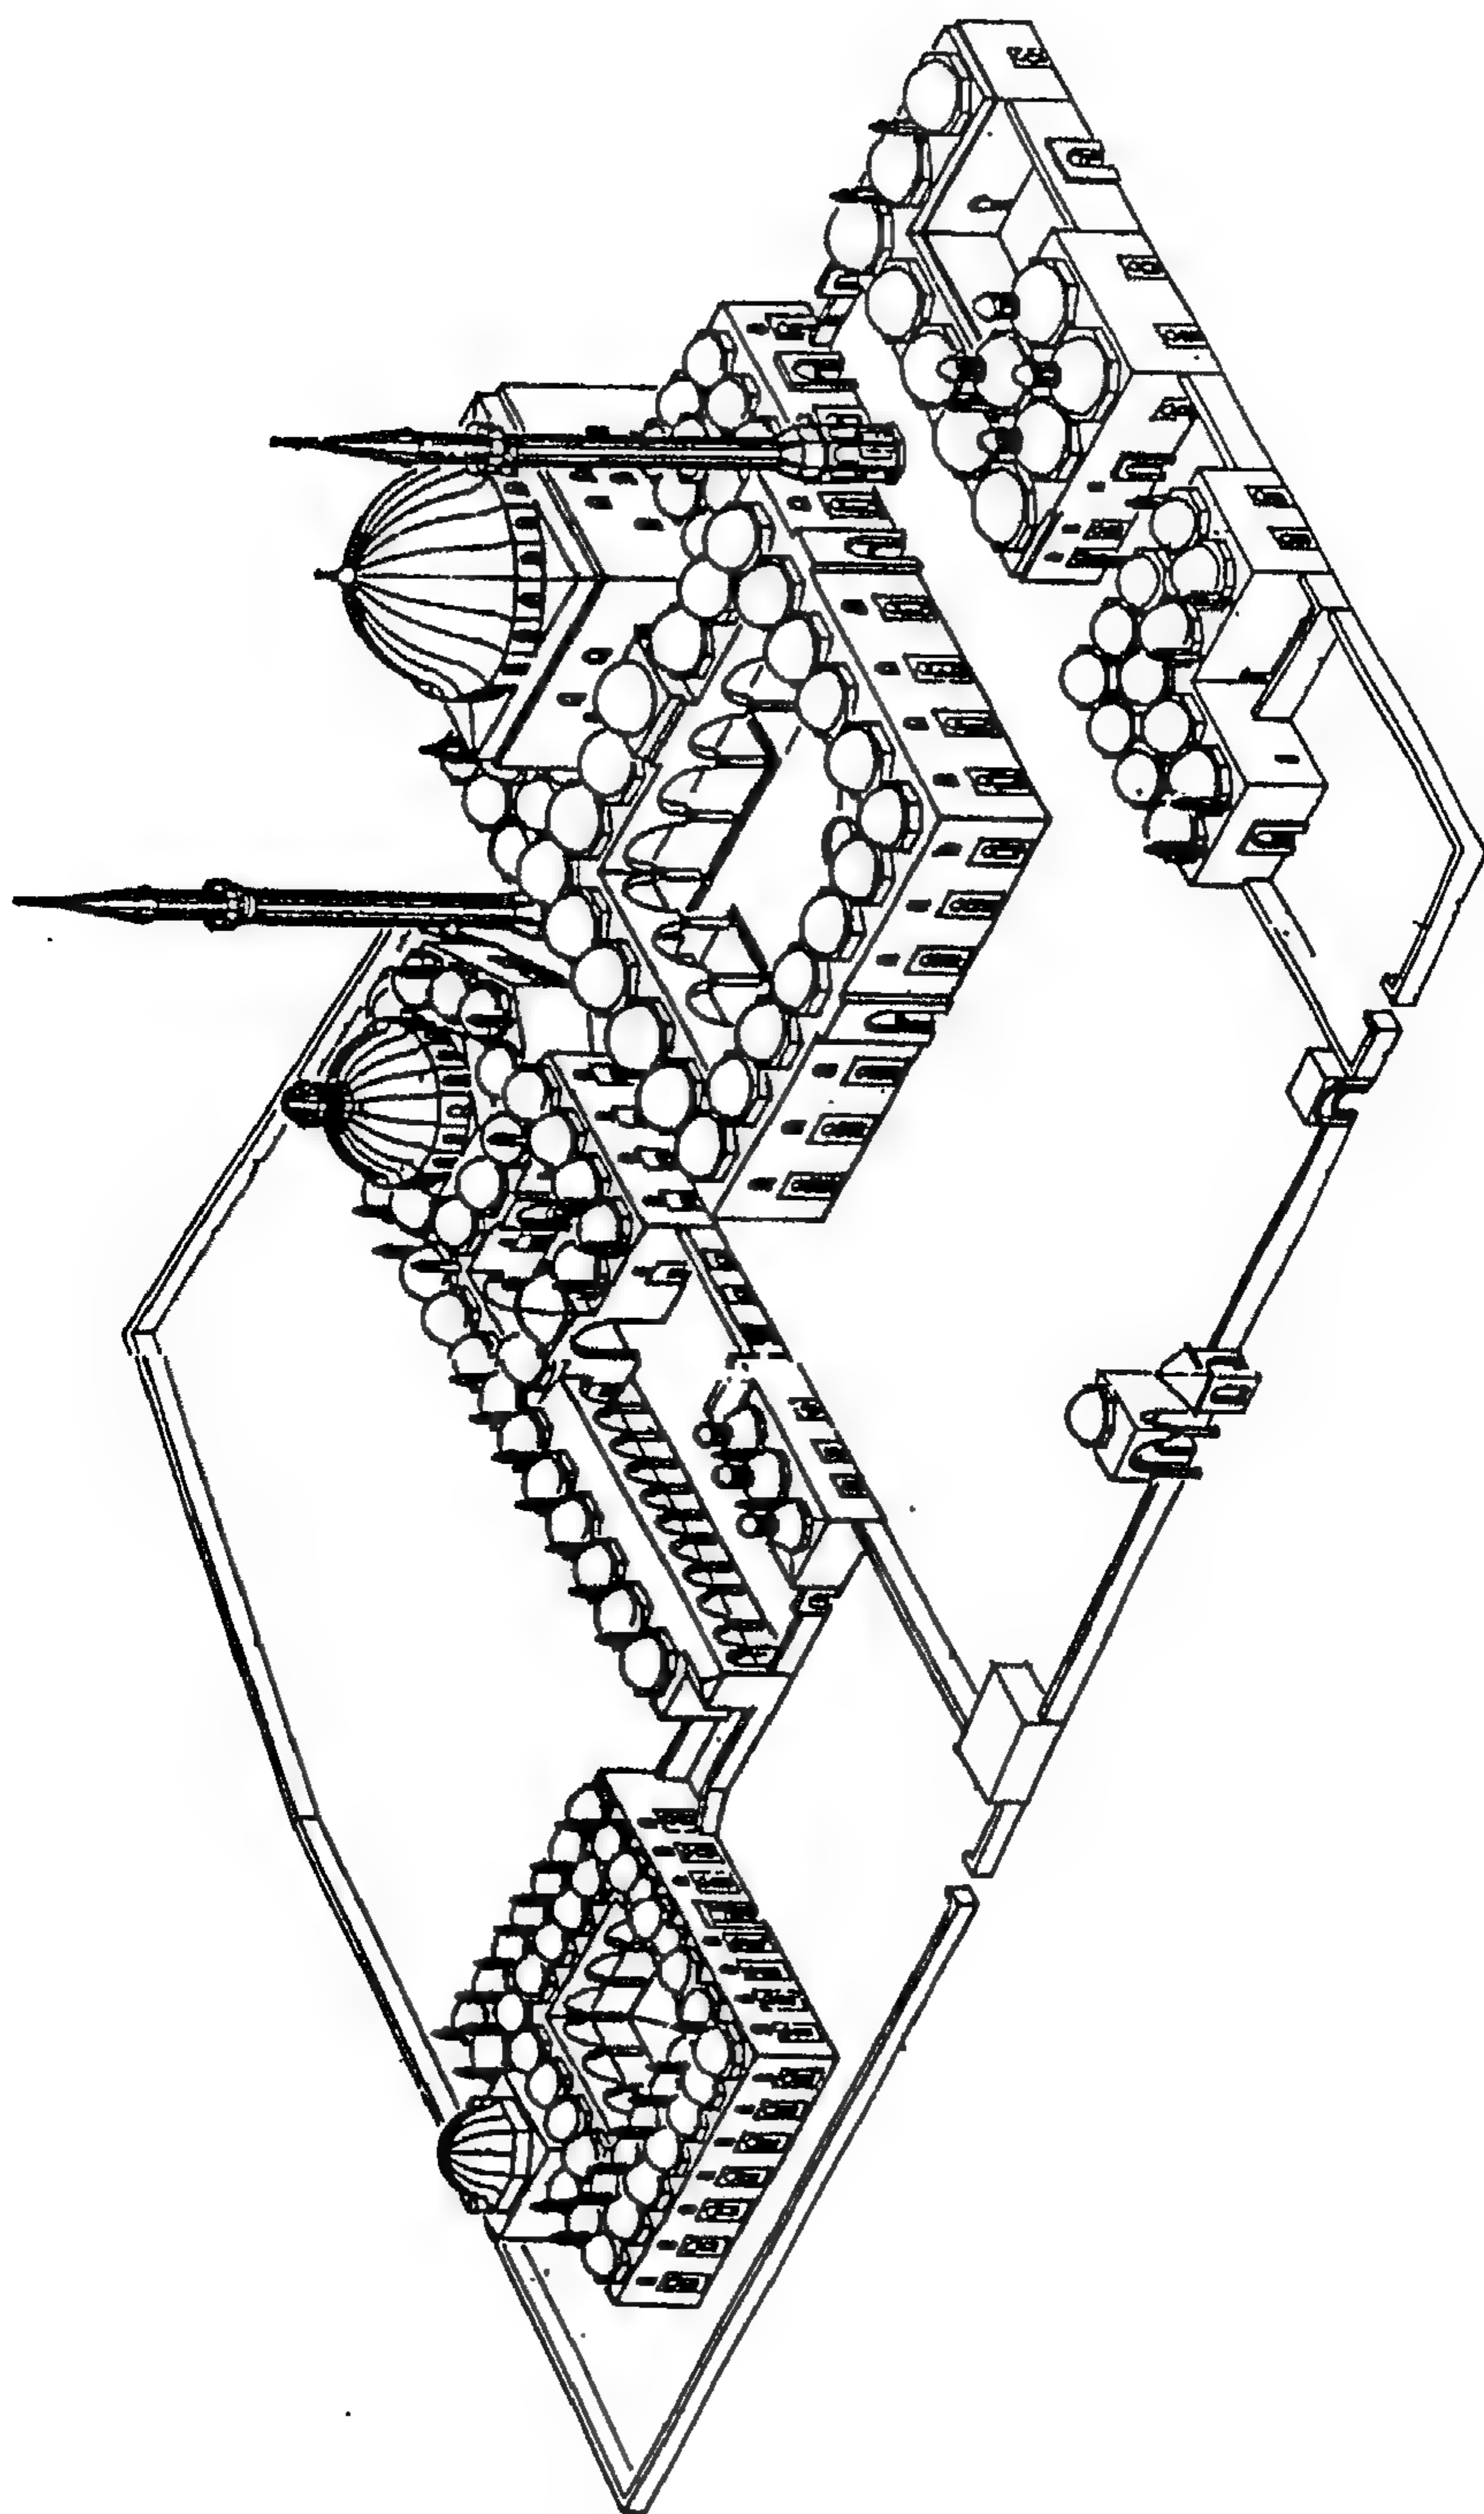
مسقط أفقي لمسجد خان في طلاس (عن : Türkmen).
